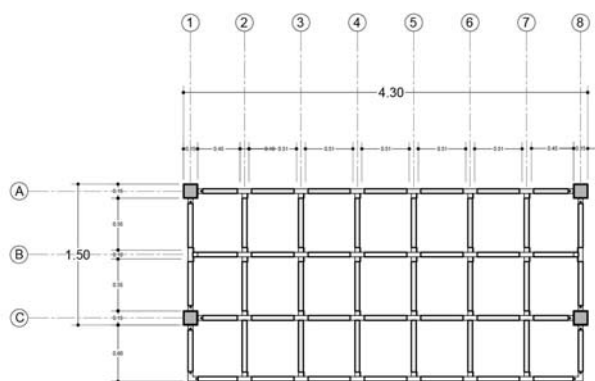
Nelly Hernandez (2018) Planta estructural (plano).
